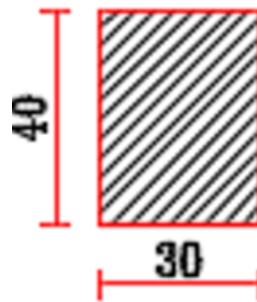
Pré-dimensionnement de la poutre palier
